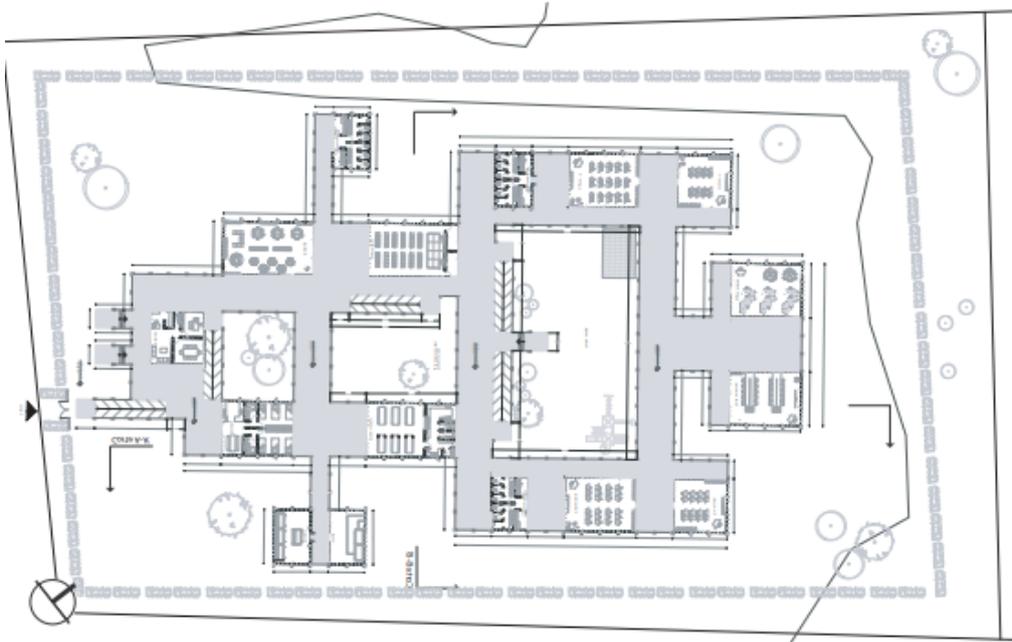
Centro de atención primaria (propuesta 1)
